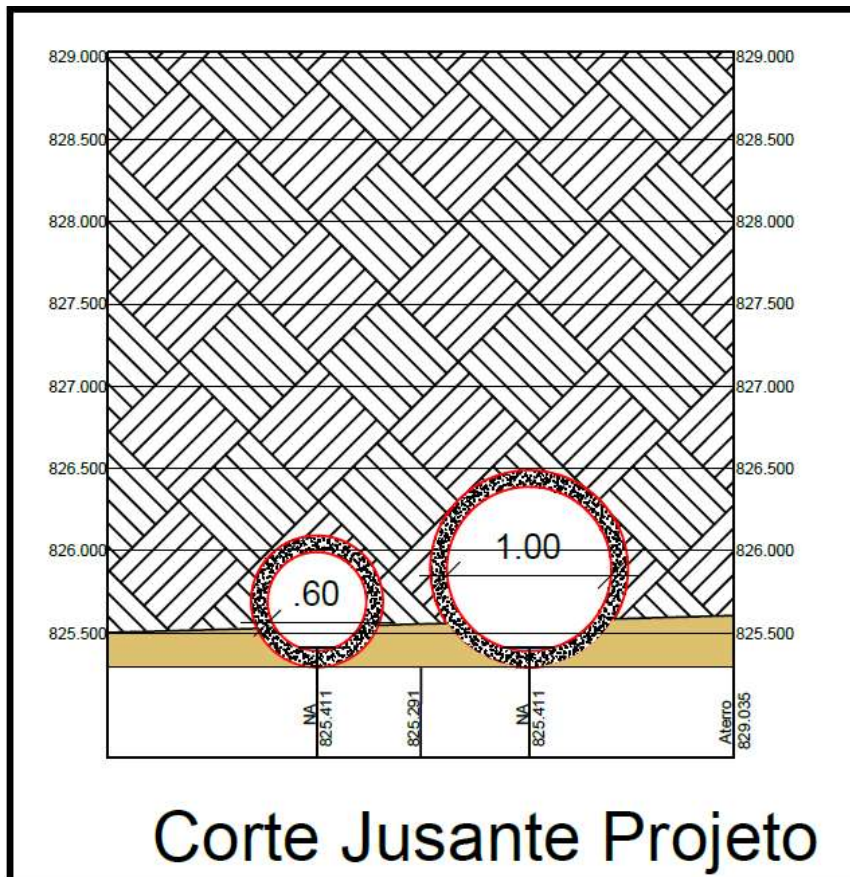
CORTE TRANSVERSAL FINAL #02
